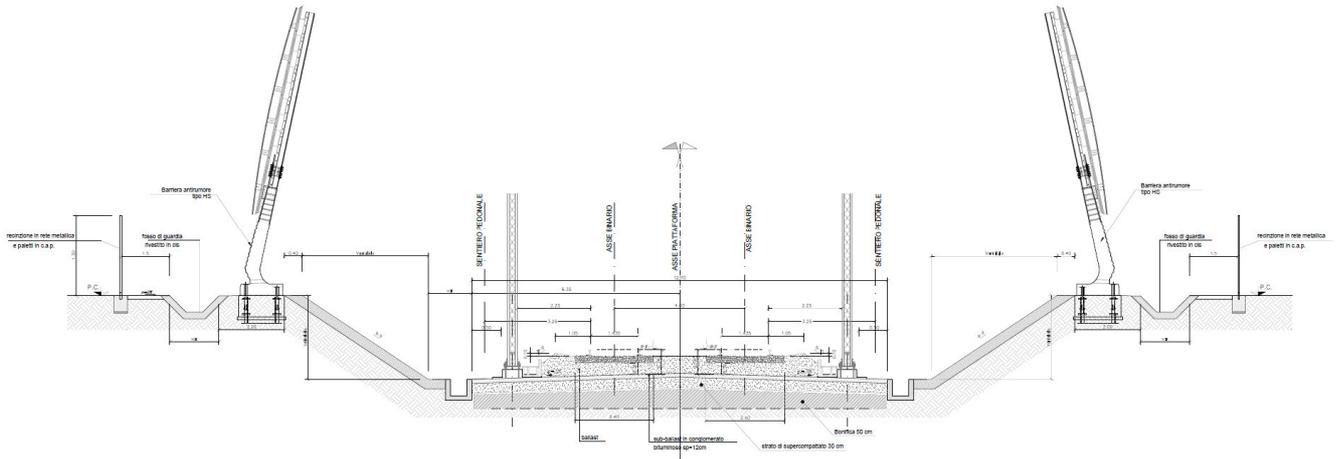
Sezione tipo in trincea tratti in affiancamento dei due semplici binari a 4 m con barriere antirumore
